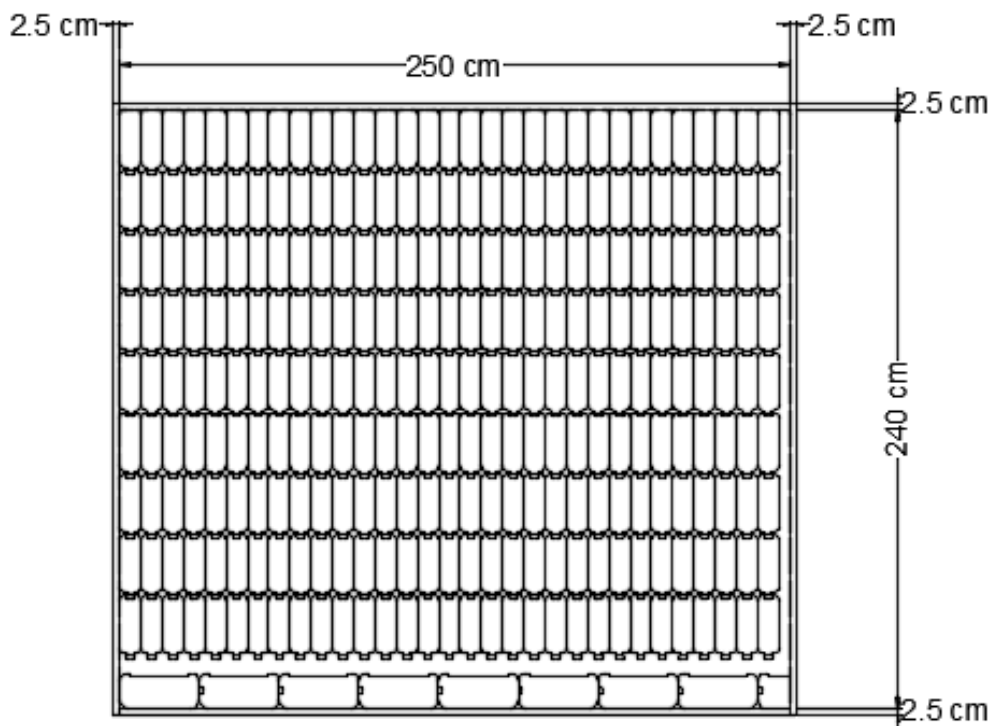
Muro verde con botellas PET diseñado por autores del presente proyecto
